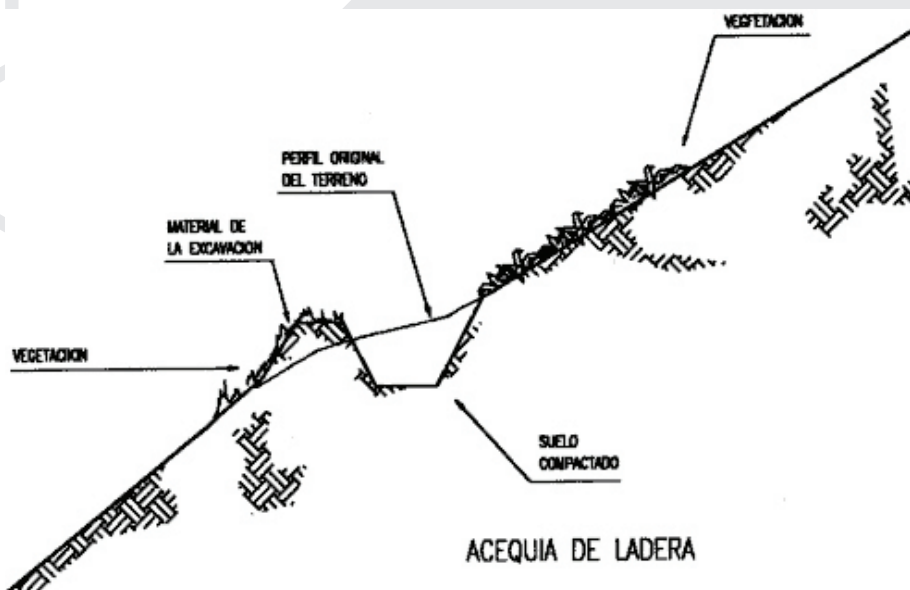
ACEQUIA DE LADERA CONSTRUIDA CON ARADO DE DISCOS
